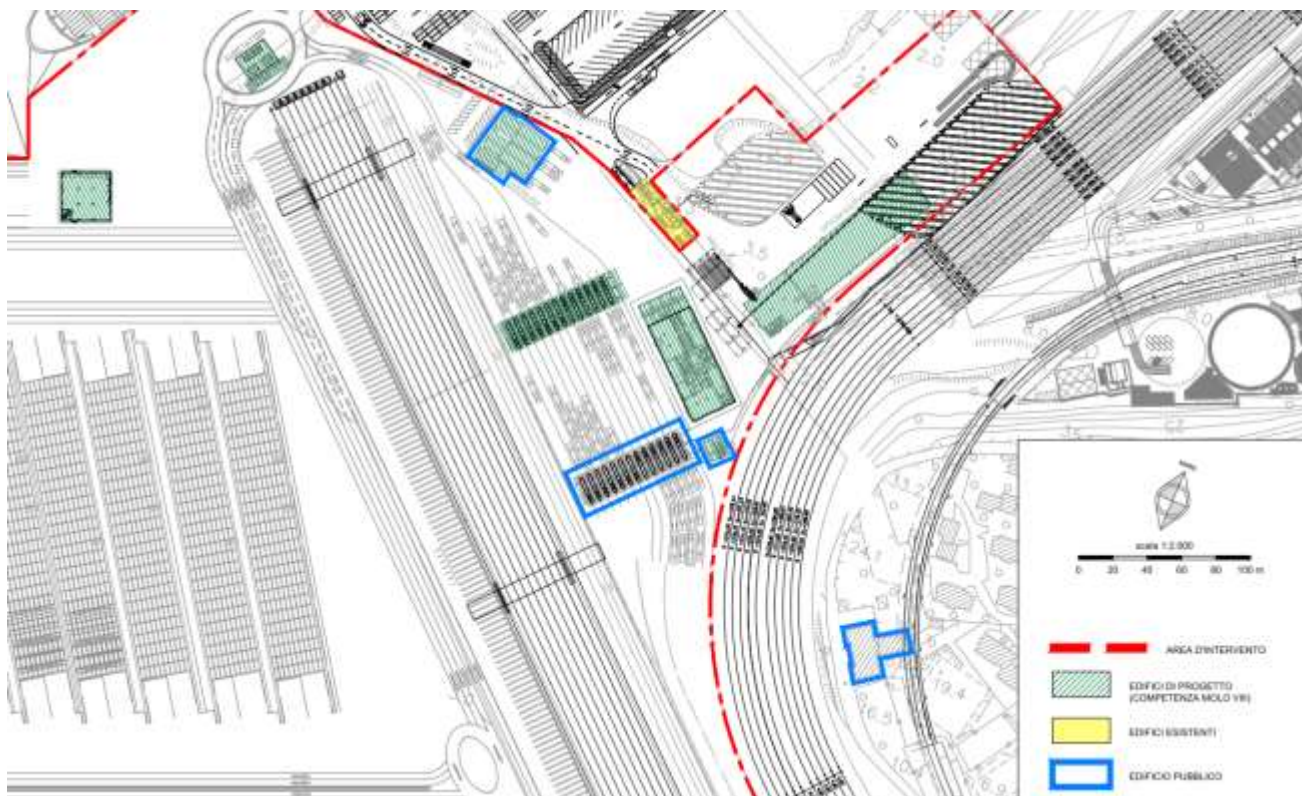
planimetria inquadramento edifici- identificati con perimetro blu
